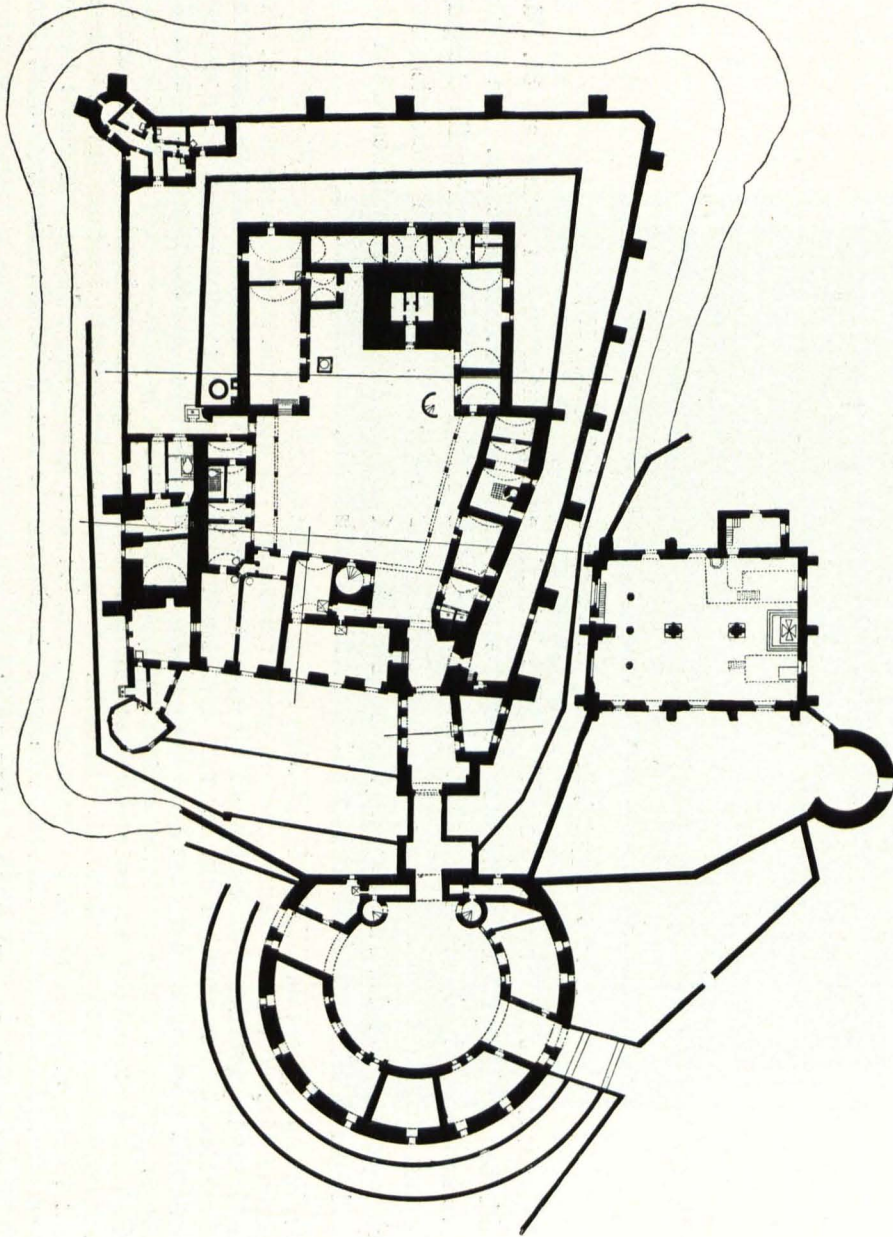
Schloß Pöggstall, Erdgeschoß, 1 : 300 (S. 186)
